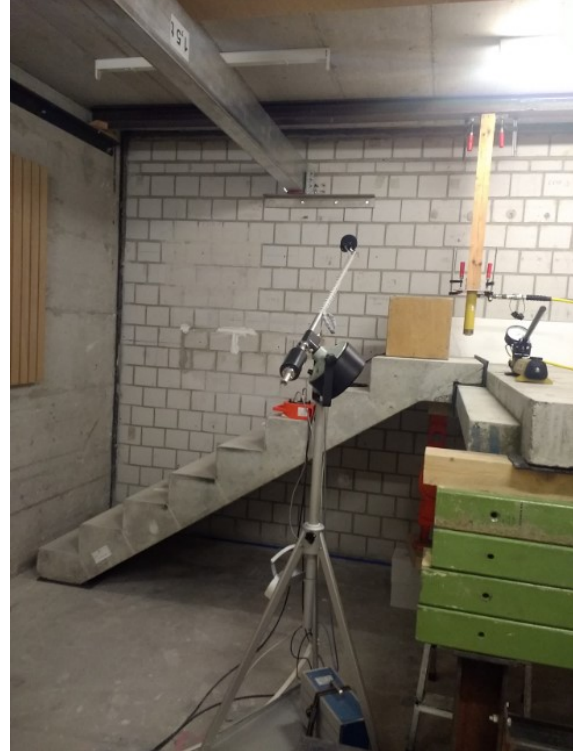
Übersicht der Einbausituation und Hammerwerkspositionen auf dem Lauf.
